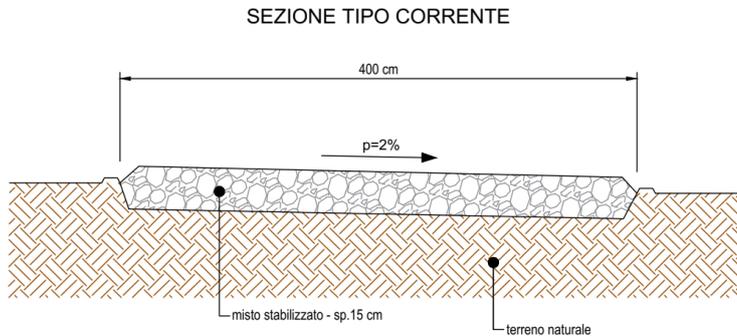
Sezione tipo delle piste interne per manutenzione (estratto di PRO_TAV_15)
